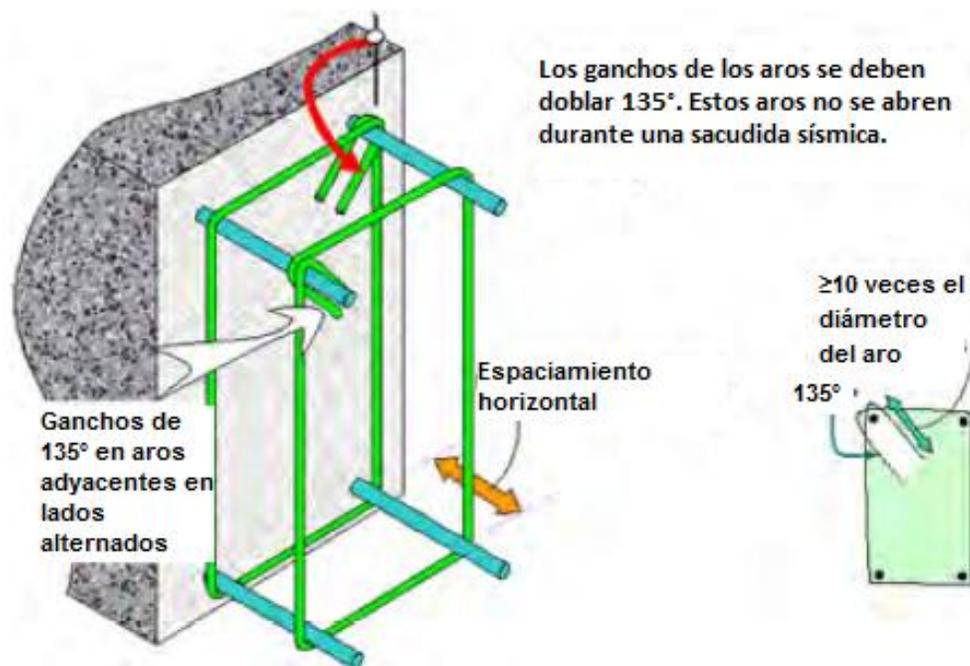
Las vigas de CR deben tener estribos con ganchos de 135° alrededor de las barras horizontales (fuente: Murty 2005).
